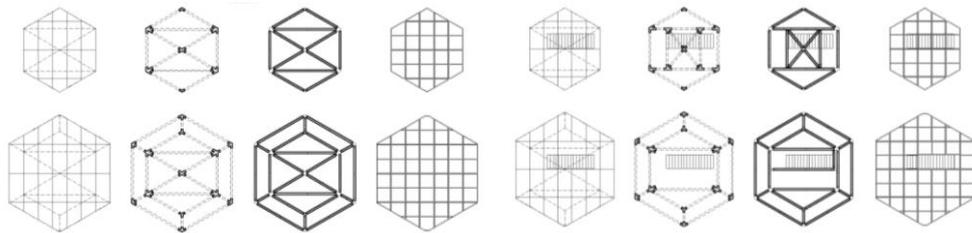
Sistema de piezas estructurales horizontales: uniones, vigas, viguetas y losas de modulo 01 y 02.
